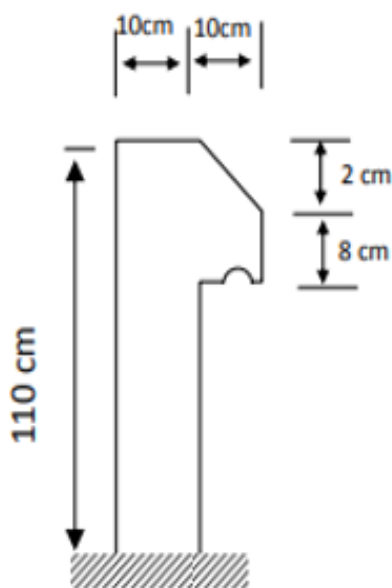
Dimensions de l'acrotère (terrasse accessible).
